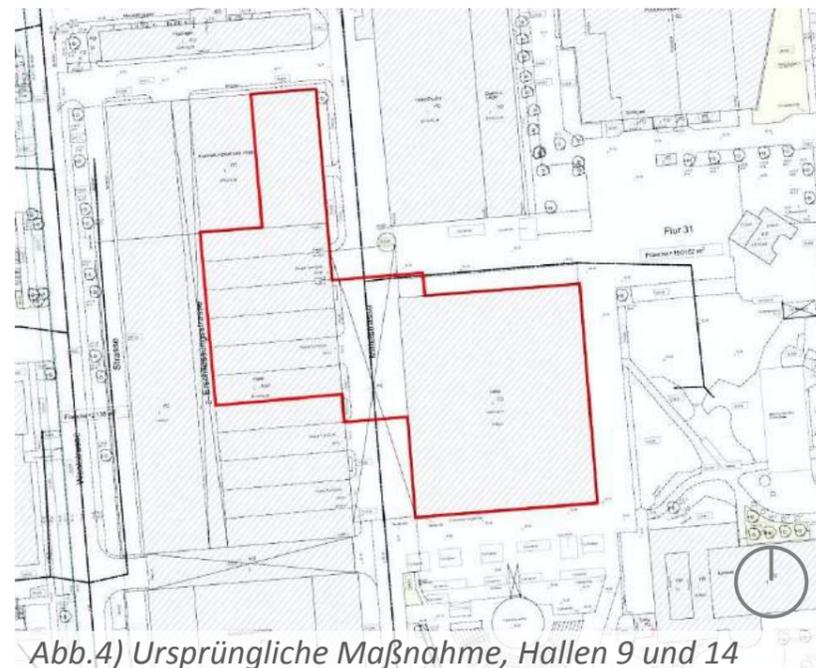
Ursprüngliche Maßnahme, Hallen 9 und 14
